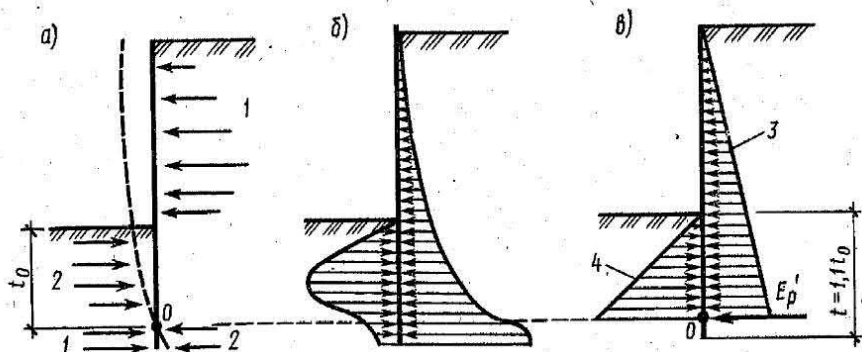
Работа безанкерной шпунтовой стенки:
